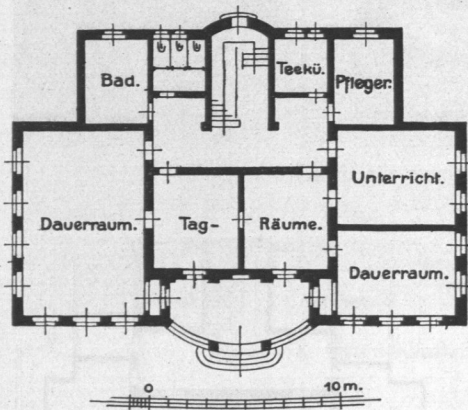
Irrenanstalt Friedrichsberg, Haus für jugendl. männliche Kranke, Erdgeschoß, Grundriß.
